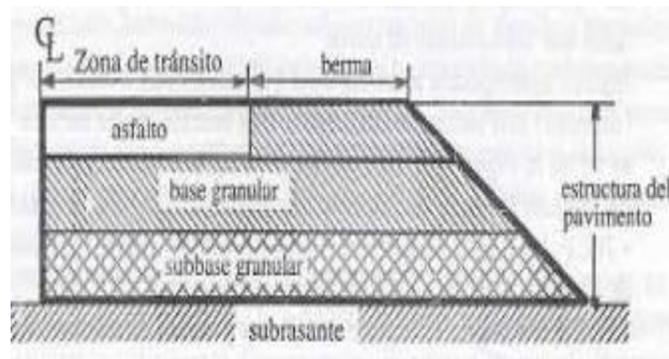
Estructura del pavimento flexible. Fuente: (MTC 2016).
